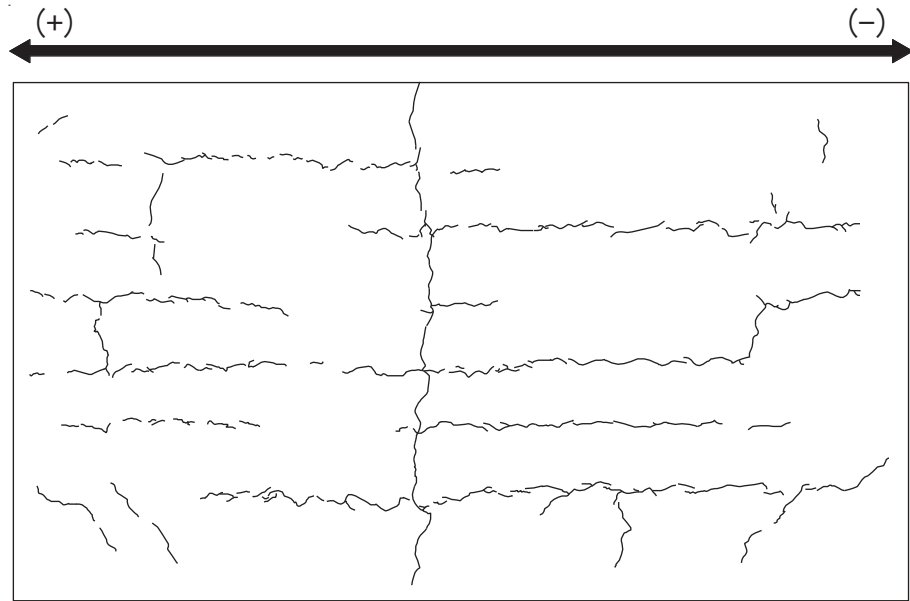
(1) 乾燥試験体 [1] 加力前におけるひび割れ図
